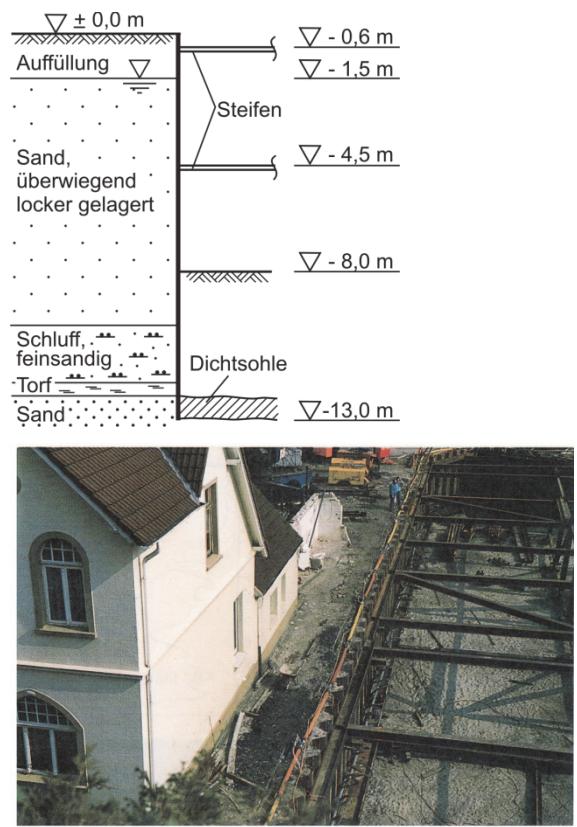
Baugrubensystem (oben) und Foto der Baugrube nach Einbringen der ersten Steifenlage (unten) [12]
